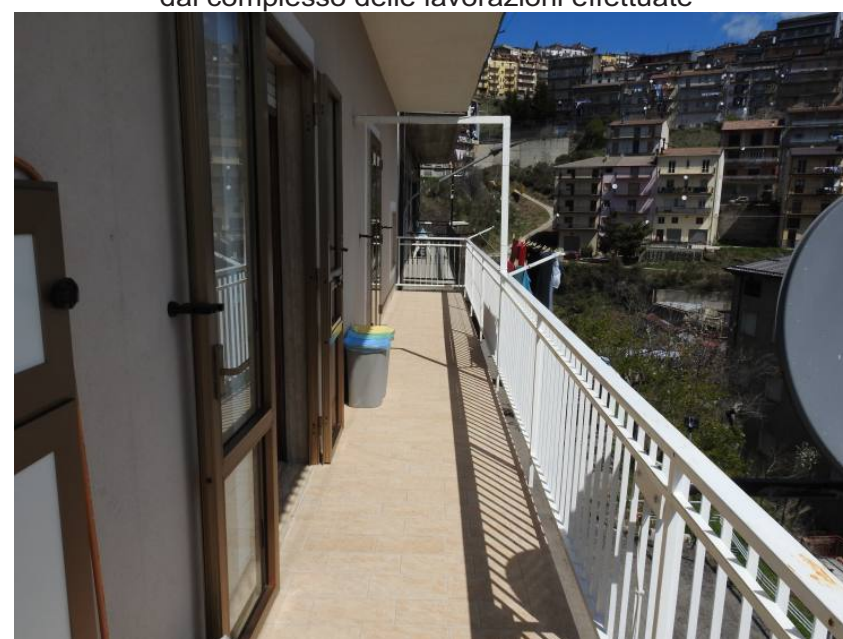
La pavimentazione del balcone del primo piano di proprietà Guglielmelli dopo i lavori ripristino
